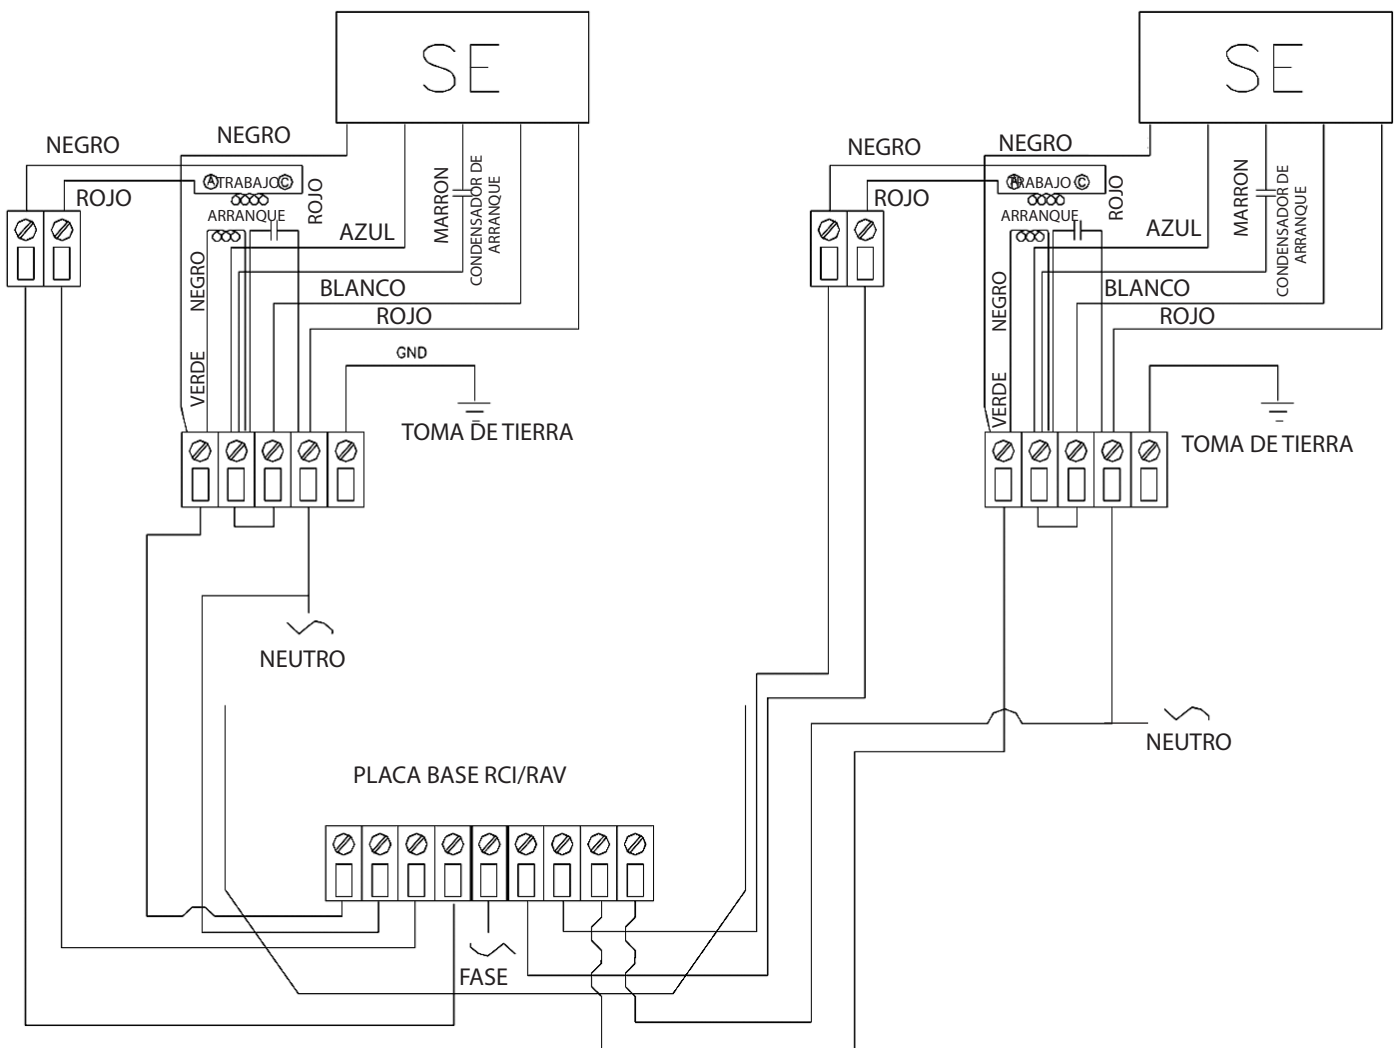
Esquema de conexiones del motor reductor MV1 al ECV
